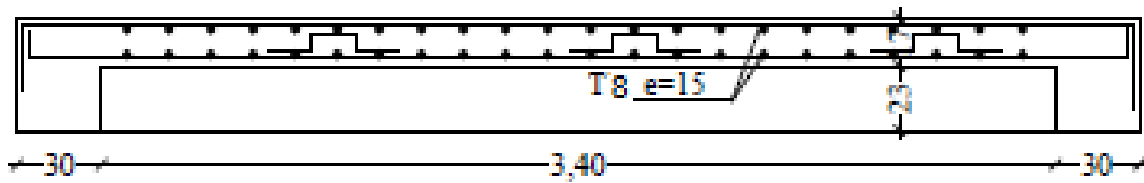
Schéma du ferrailage de la dalle pleine de minaret Pour 1^{er}, 2^{ème}, 3^{ème}, 4^{ème} et 5^{ème} étage
